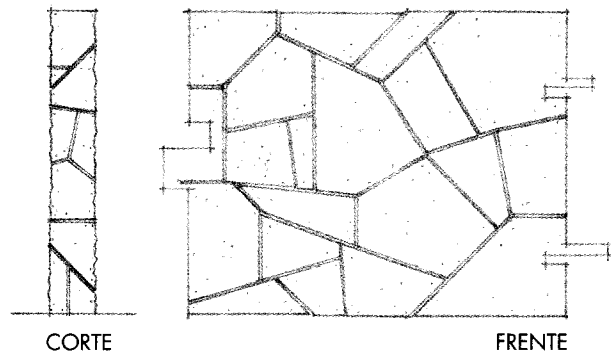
Muro de piedra con cantos labrados irregulares y juntas prácticamente sin mortero (a hueso).
